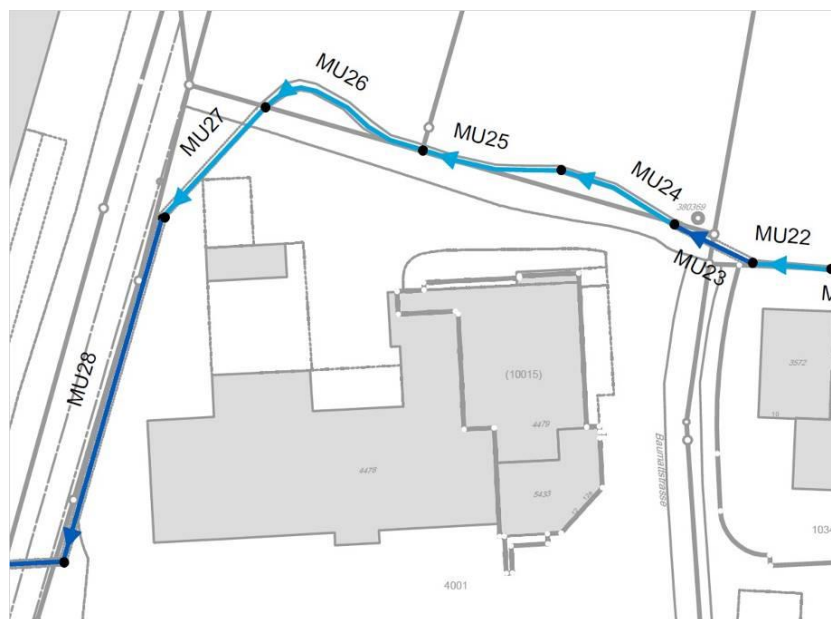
; Ausschnitt aus Plan Haltungen GEP (Genereller Entwässerungsplan) Berechnung (ohne Massstab)
